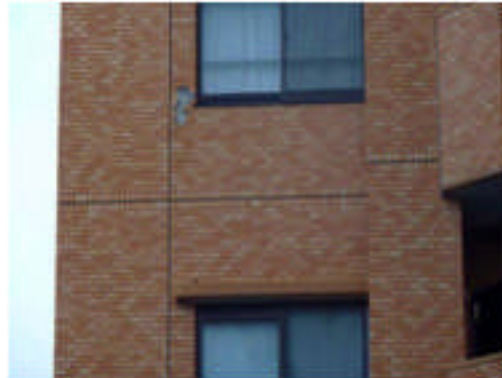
非構造壁の損傷（ひび割れ）
